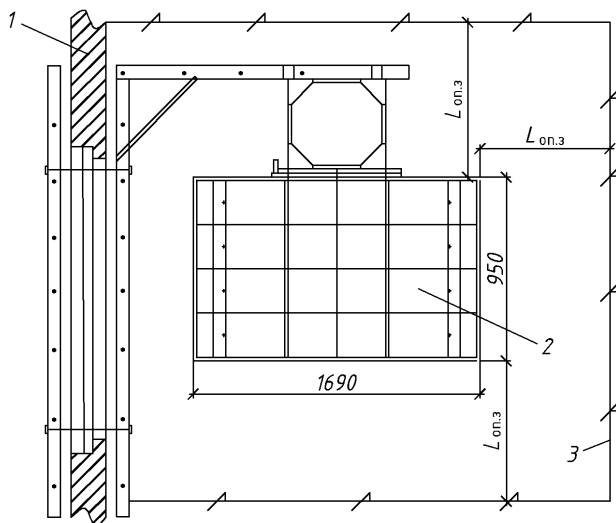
Определение опасной зоны при работе грузового подъёмника:
